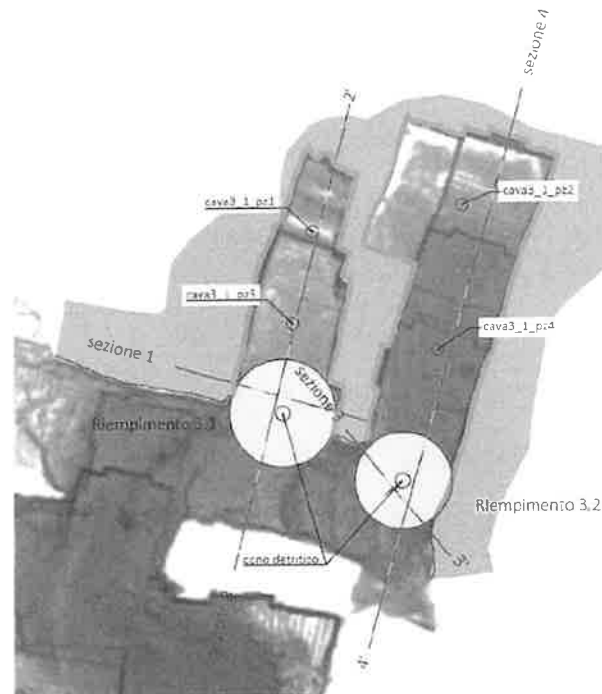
Dettaglio della planimetria di Cava 3 - Area 1
